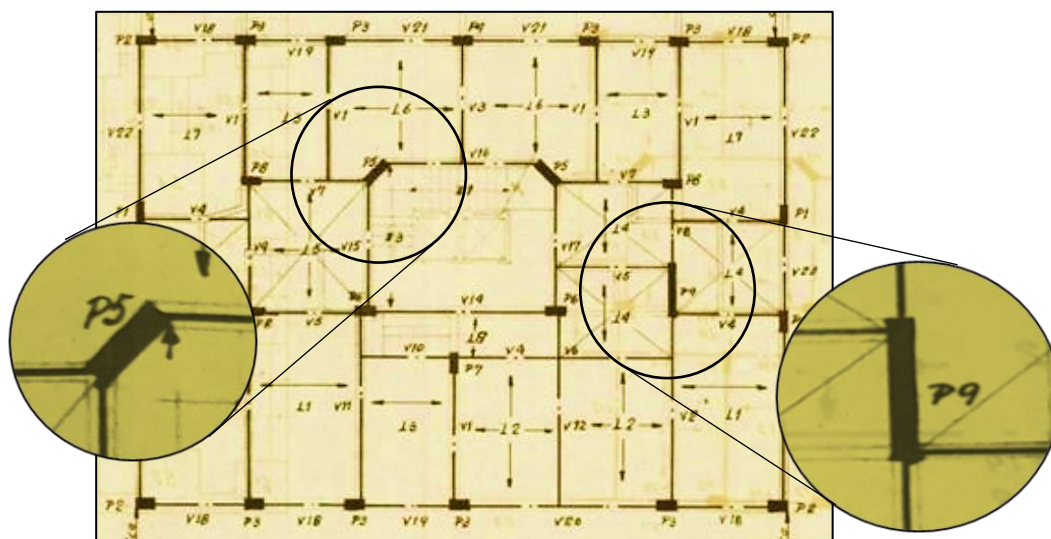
Pormenorização da planta com destaque no pilar enviesado e no pilar comprido
